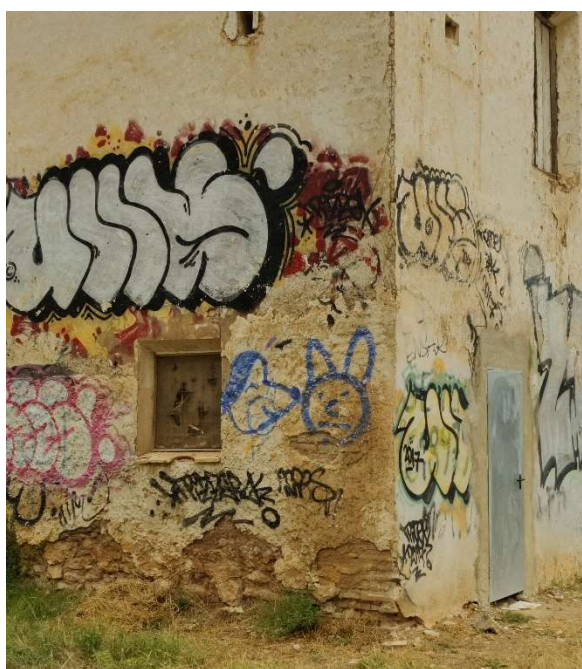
Fachada oeste de la Alquería de Falcó, 2021.
